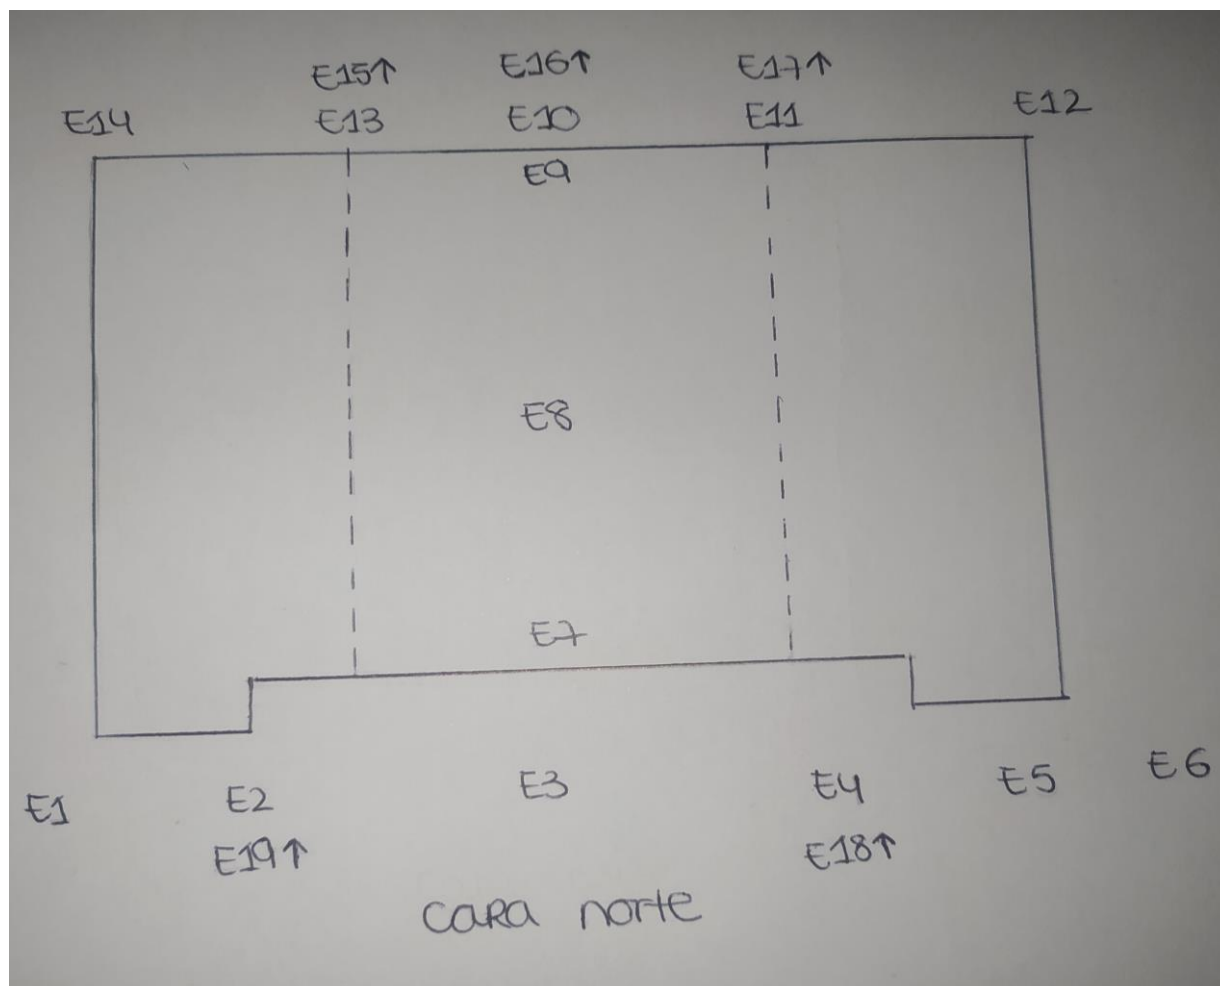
Croquis de la planta del puente con las posiciones de los estacionamientos. Fuente: elaboración propia
